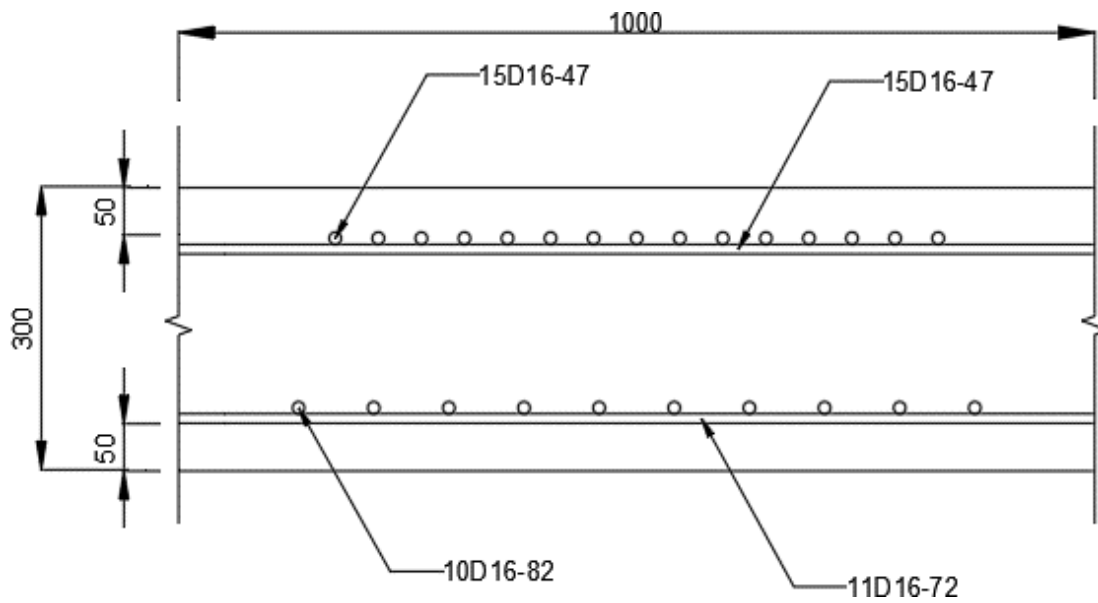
Desain Penulangan Balok Tipe -2 (Balok Longitudinal) Keterangan : Satuan Dalam mm
